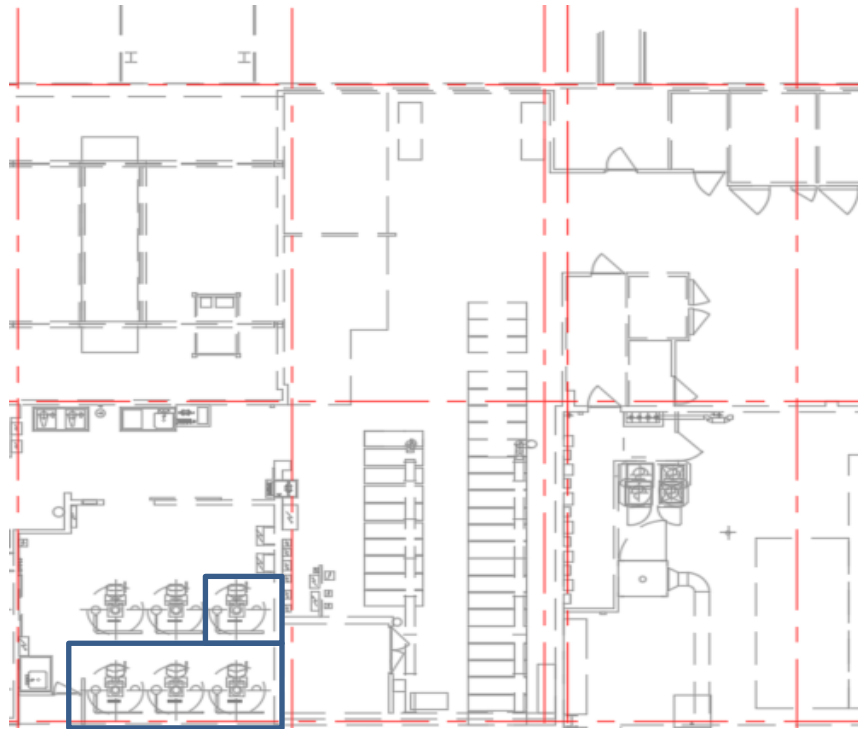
Layout del área proyectada para la instalación del sistema.
